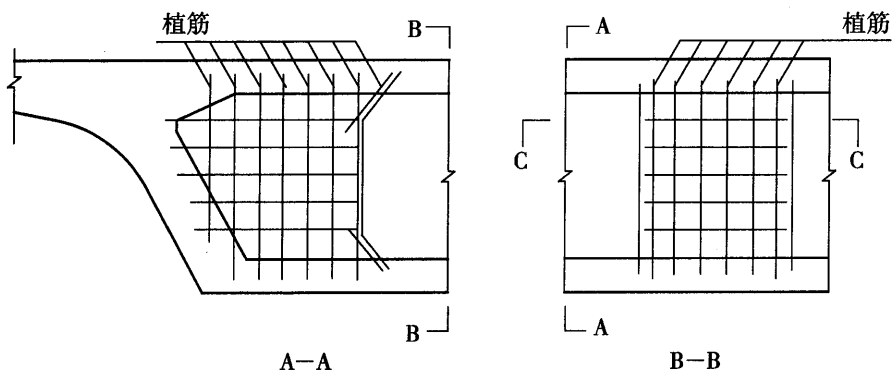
锚固横隔板受力钢筋布置示意图
